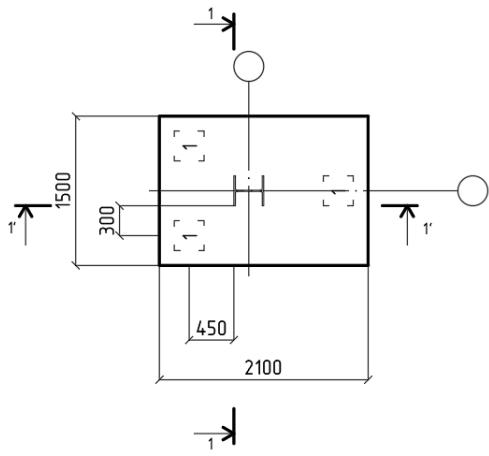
Схема к расчету ростверка на изгиб
